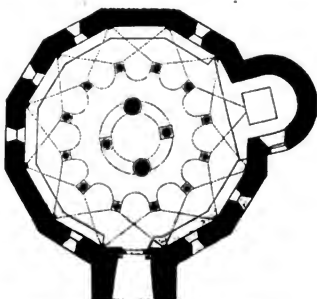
Grundriss der Kapelle zu Drüggelte.
